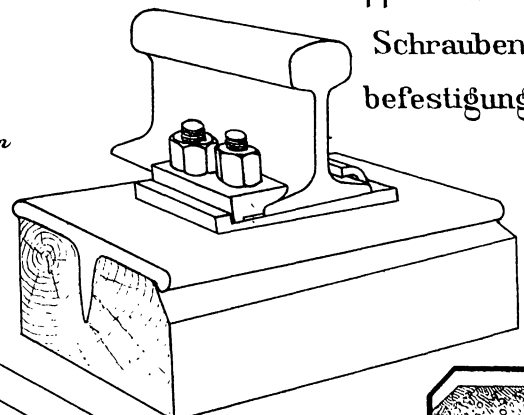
Oberbau mit Rippenschwelle und Schraubenbefestigung.
